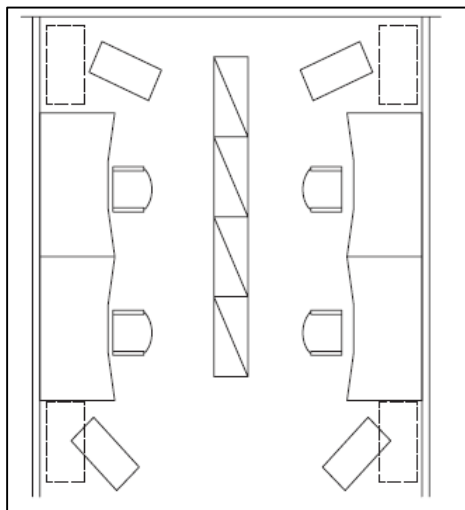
Beispiel für den Grundriss eines Gruppenbüros mit Orientierung zur Wand²⁵
